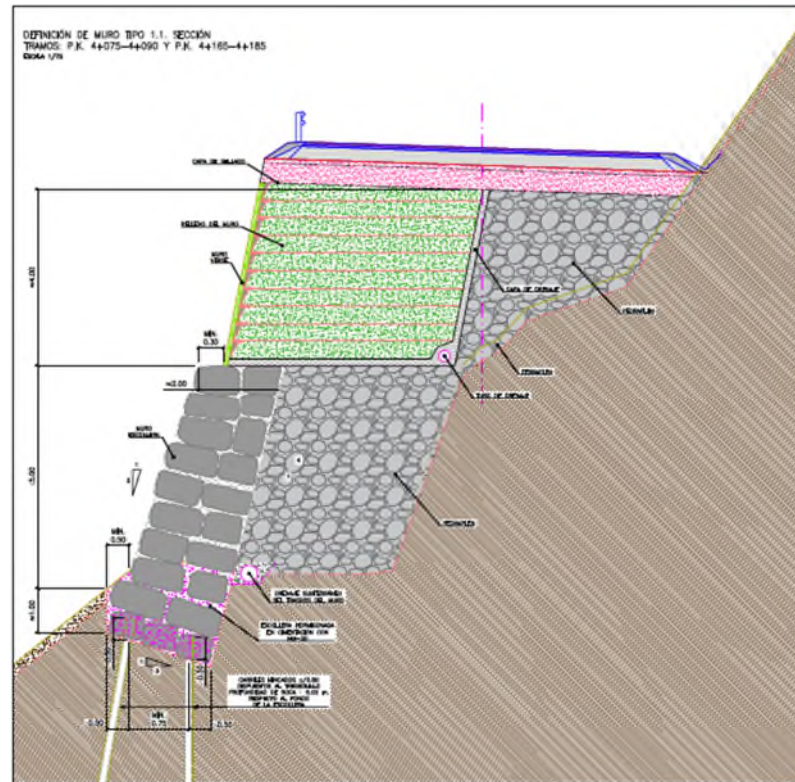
Estructura de escolleras, carriles hincados y muros verdes, prevista entre los pK 4+080 y 4+540 (Pueyo, 2025).
